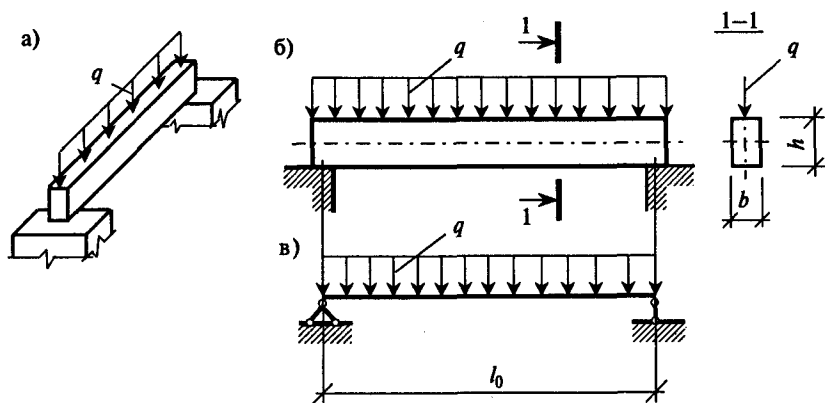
Прямой поперечный изгиб балки от равномерно распределенной нагрузки: а) аксонометрическая схема балки; б) конструктивная схема балки; в) расчетная схема балки
